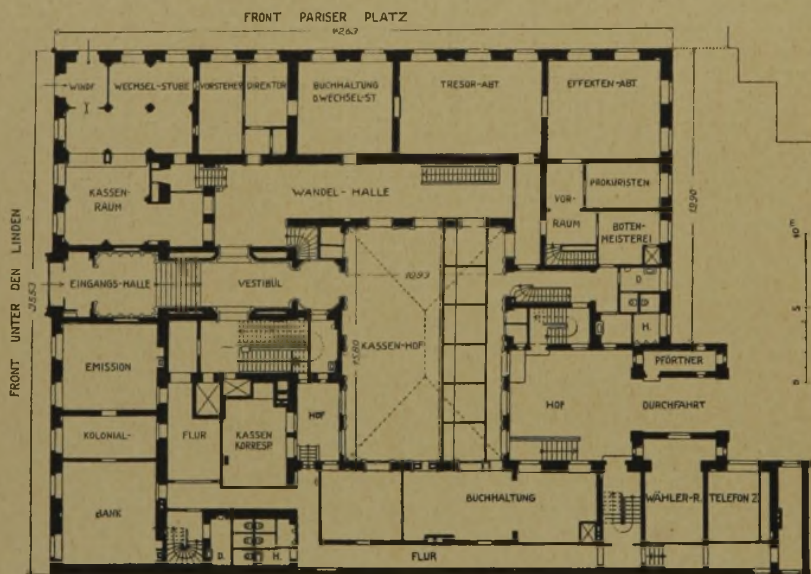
Grundriß des Erdgeschosses i. M. 1:500.
